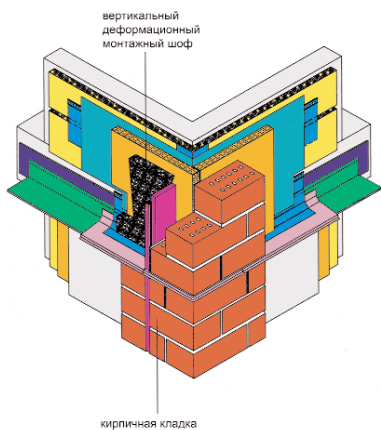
г Техническое решение конструкции трехслойной стены на внешнем углу [1.24]
